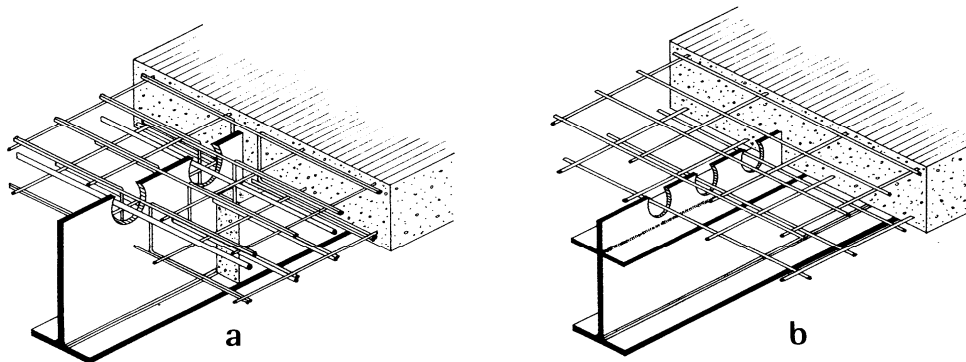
Ausführungsbeispiele für Verbundträger mit Betondübeln, aus [19]
